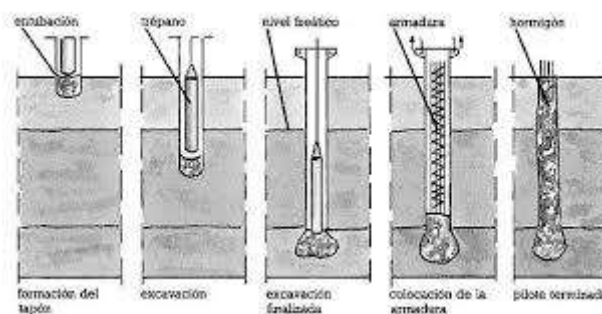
Procedimiento para construcción de Pilotes preexcavados In Situ. Fuente. Suarez (1988).
